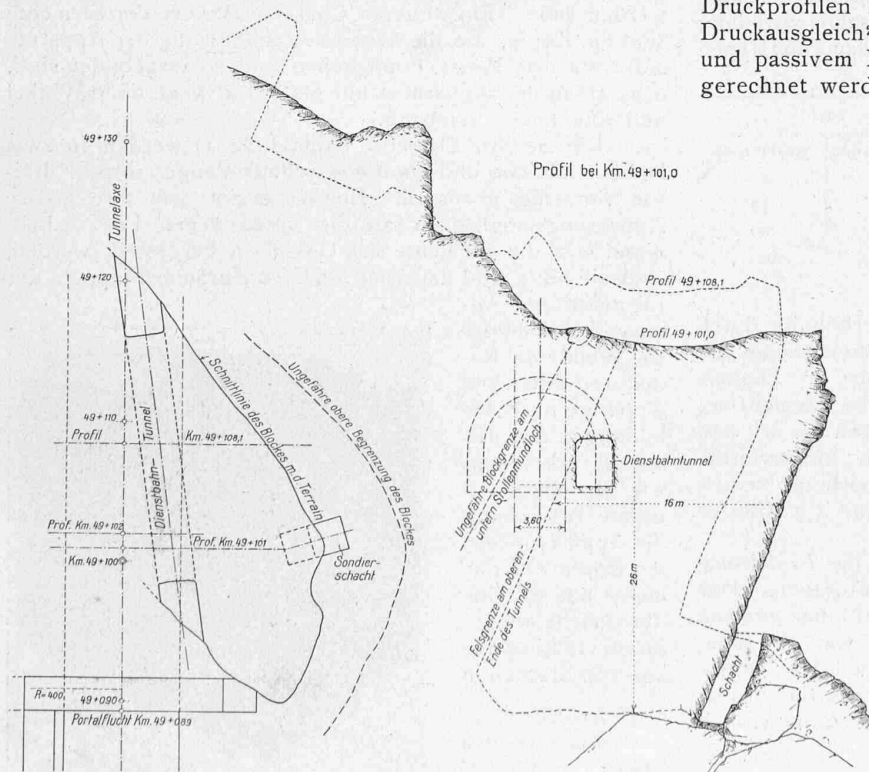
u. 62. Viktoria-Tunnel, Grundriss und Profil bei Km. 49,101. — 1 : 500.
